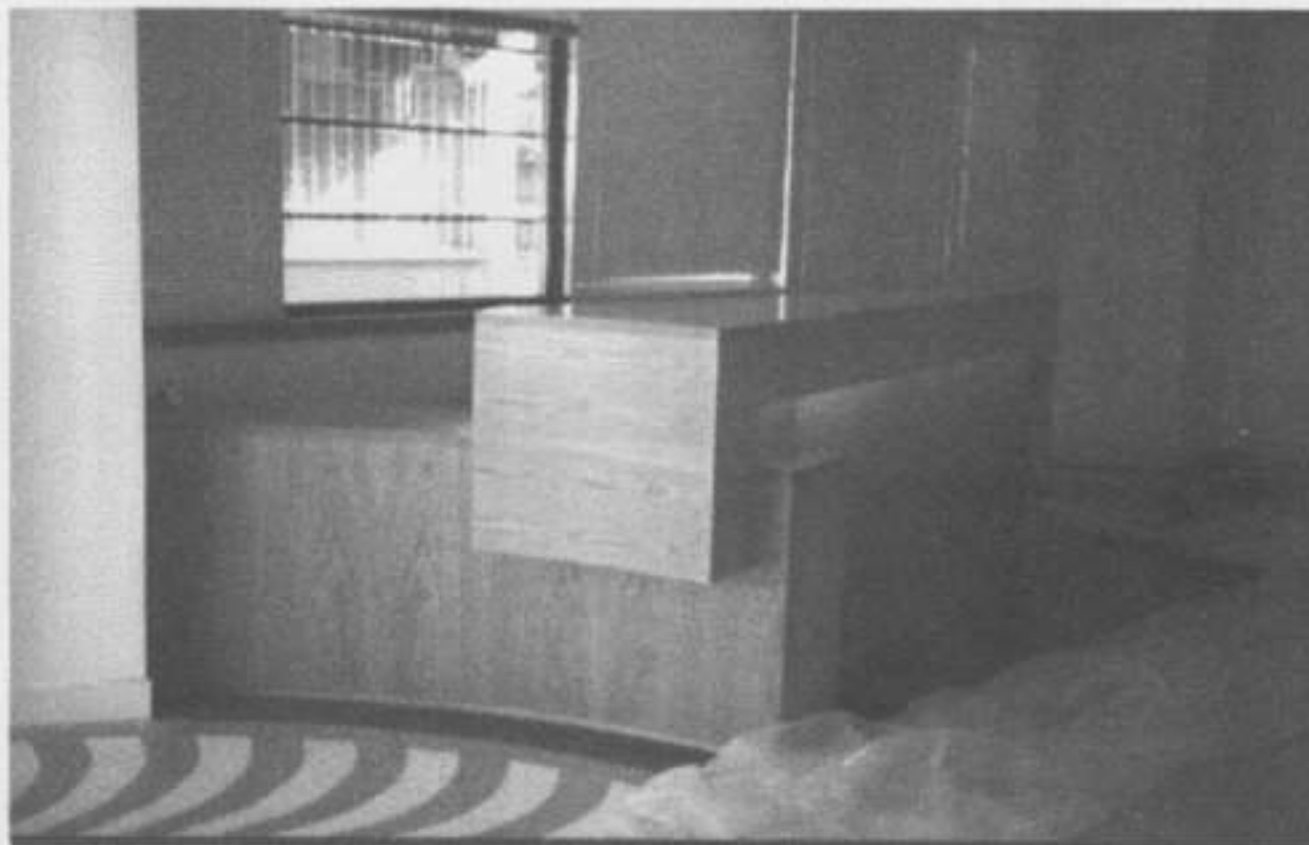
Balcão recepção em carvalho e chapa metálica microperfurada, cota 99.90
